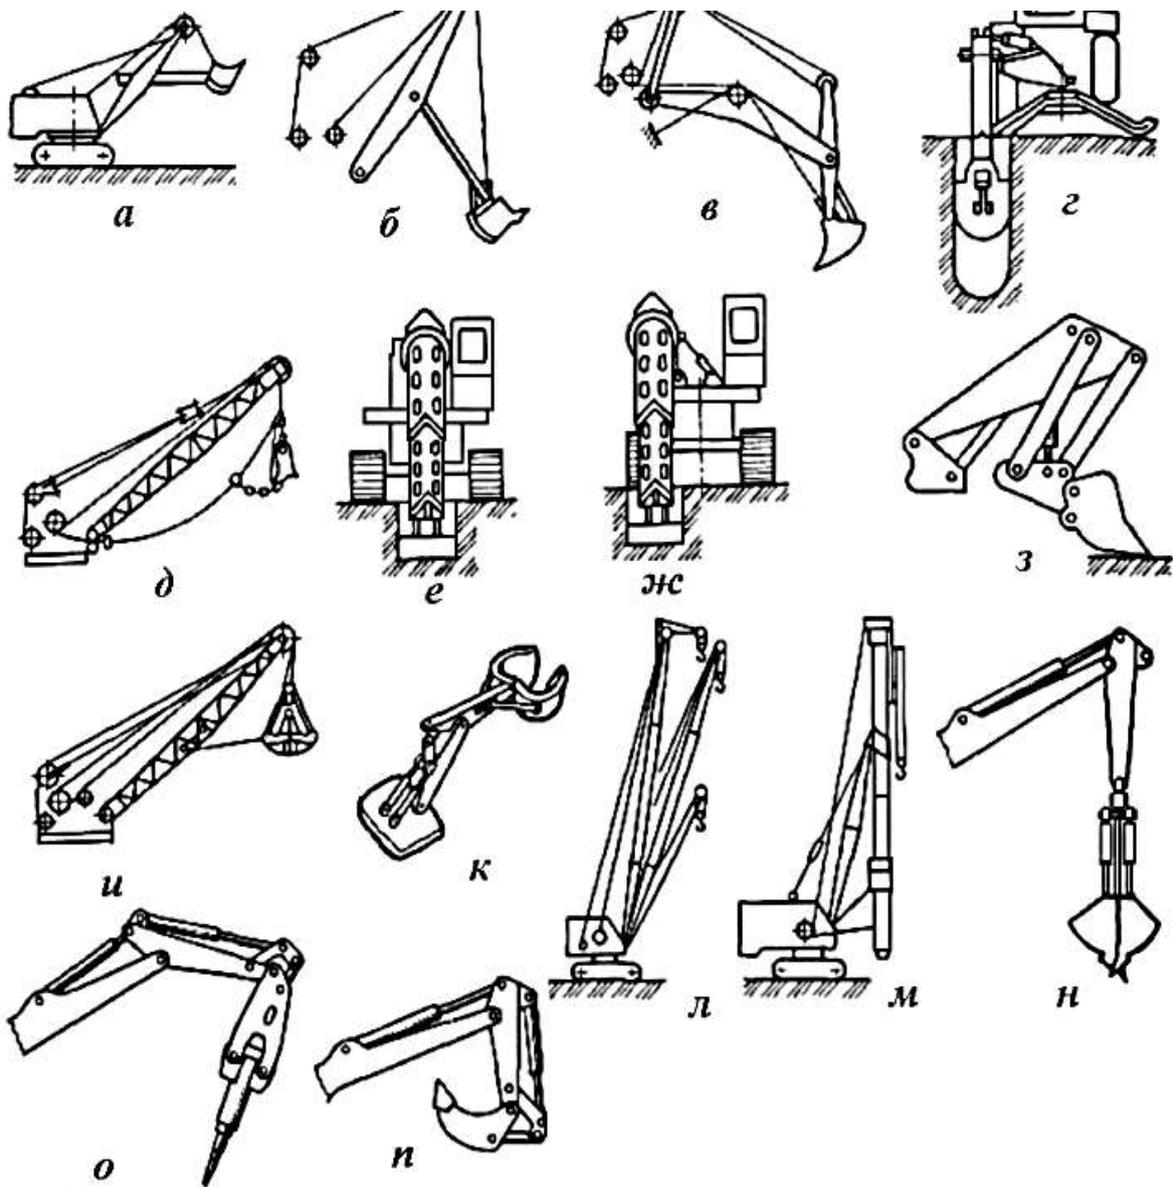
Основные виды рабочего оборудования одноковшового экскаватора: *а* – прямая лопата с принудительным напором; *б* – маятниковая прямая лопата; *в* – обратная лопата; *г* – боковая обратная лопата; *д* – драглайн; *е* – планировочное телескопическое оборудование; *жс* – боковое телескопическое оборудование; *з* – погрузочное оборудование; *и* – грейфер на канатной подвеске; *к* – челюстной захват; *л* – кран; *м* – копер; *н* – грейфер на жесткой подвеске; *о* – молот; *п* – рыхлитель.
